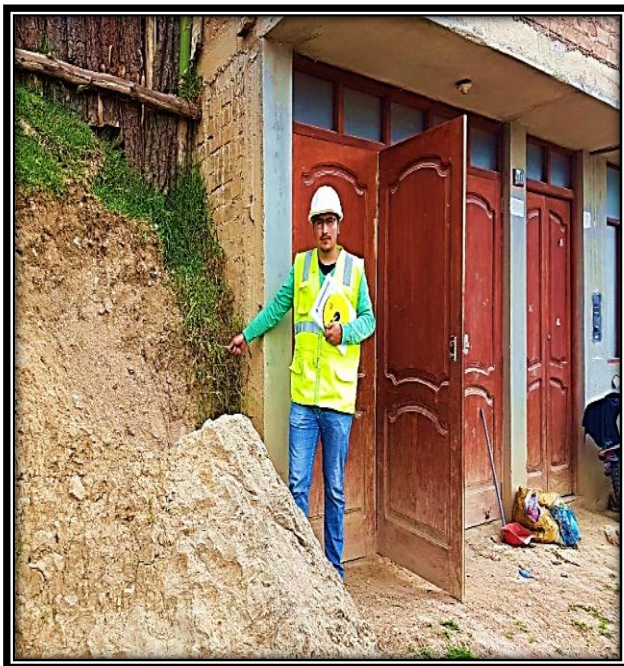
Problema de uniformidad en planta y elevación - Jesús
